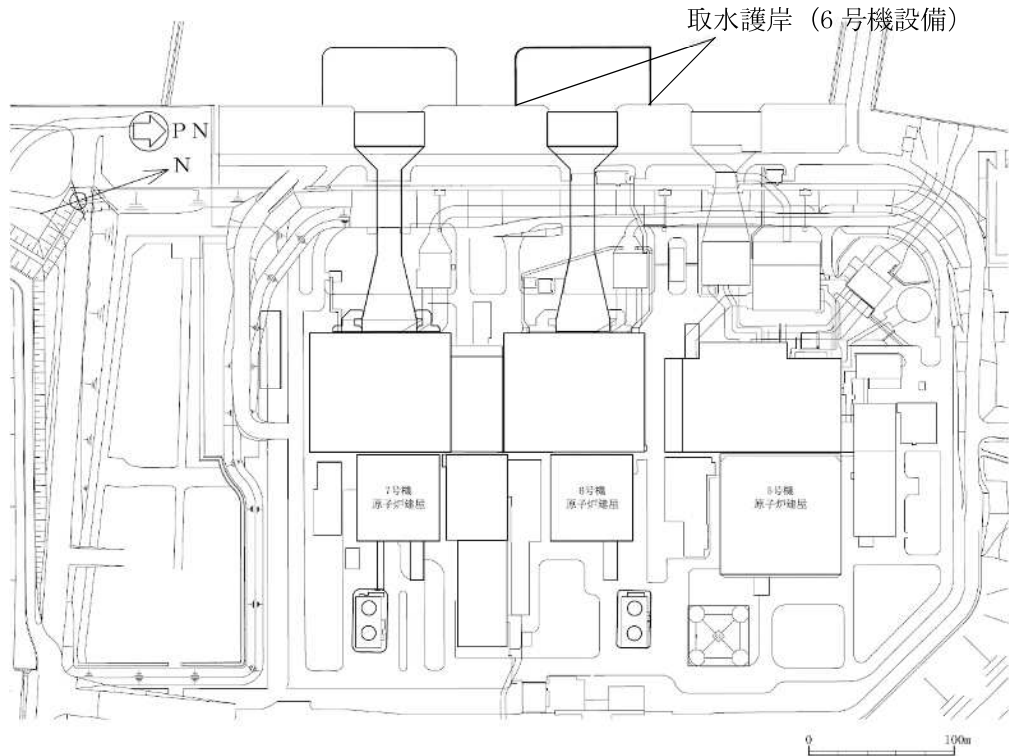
(1) 取水護岸（6号機設備）の位置図（全体平面図）
